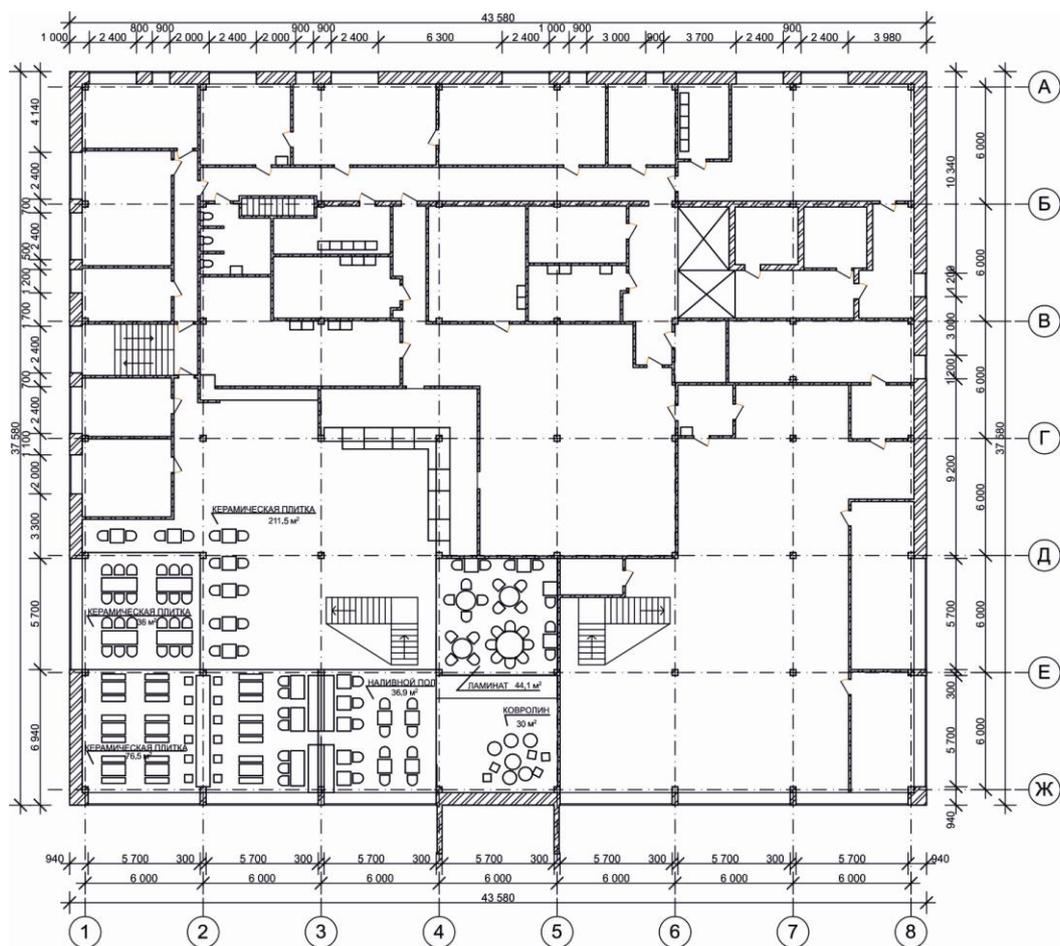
План пола 2го этажа с расстановкой оборудования
